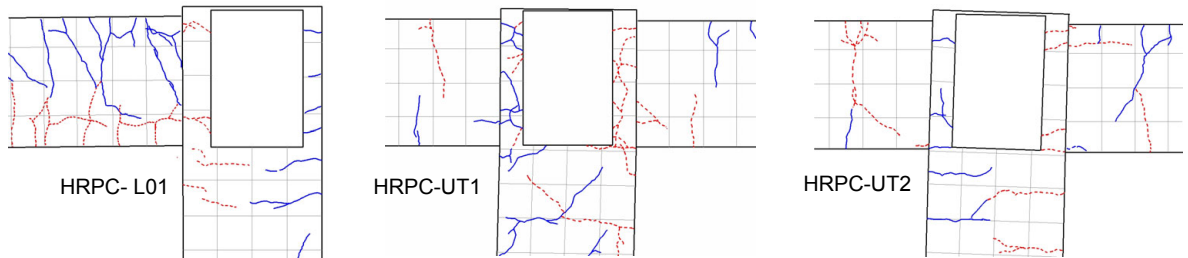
ひび割れ発生状況 (1/50rad.)
